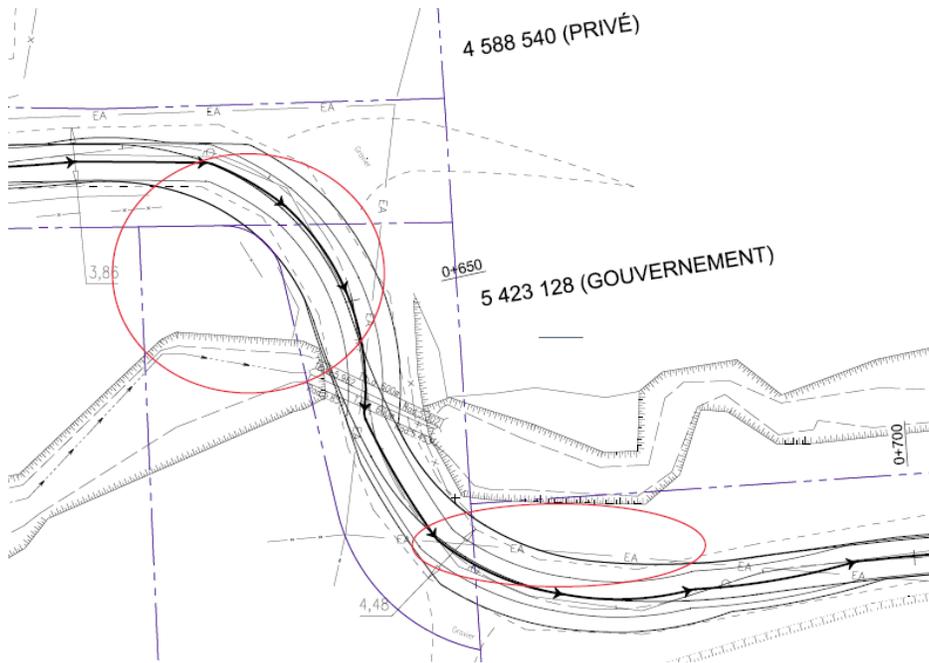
Dépassement plate-forme carrossable 0+635 à 0+685
